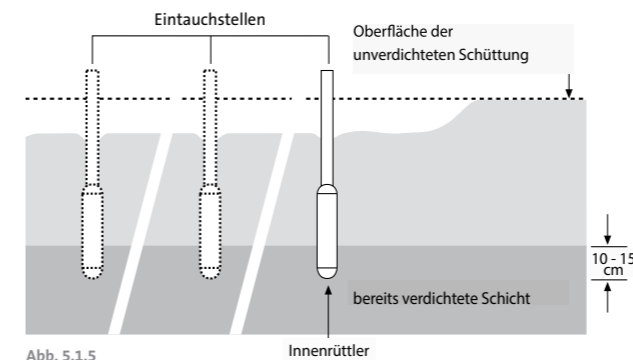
Frischbetoneinbau und Verdichtung
